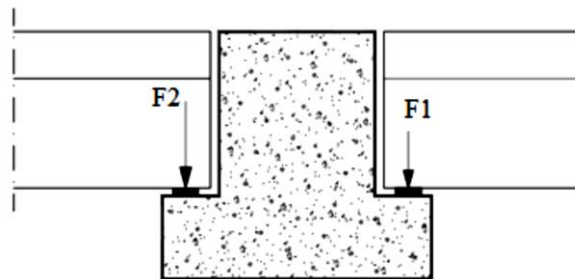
Viga de suporte com consolas curtas inferiores [3].
